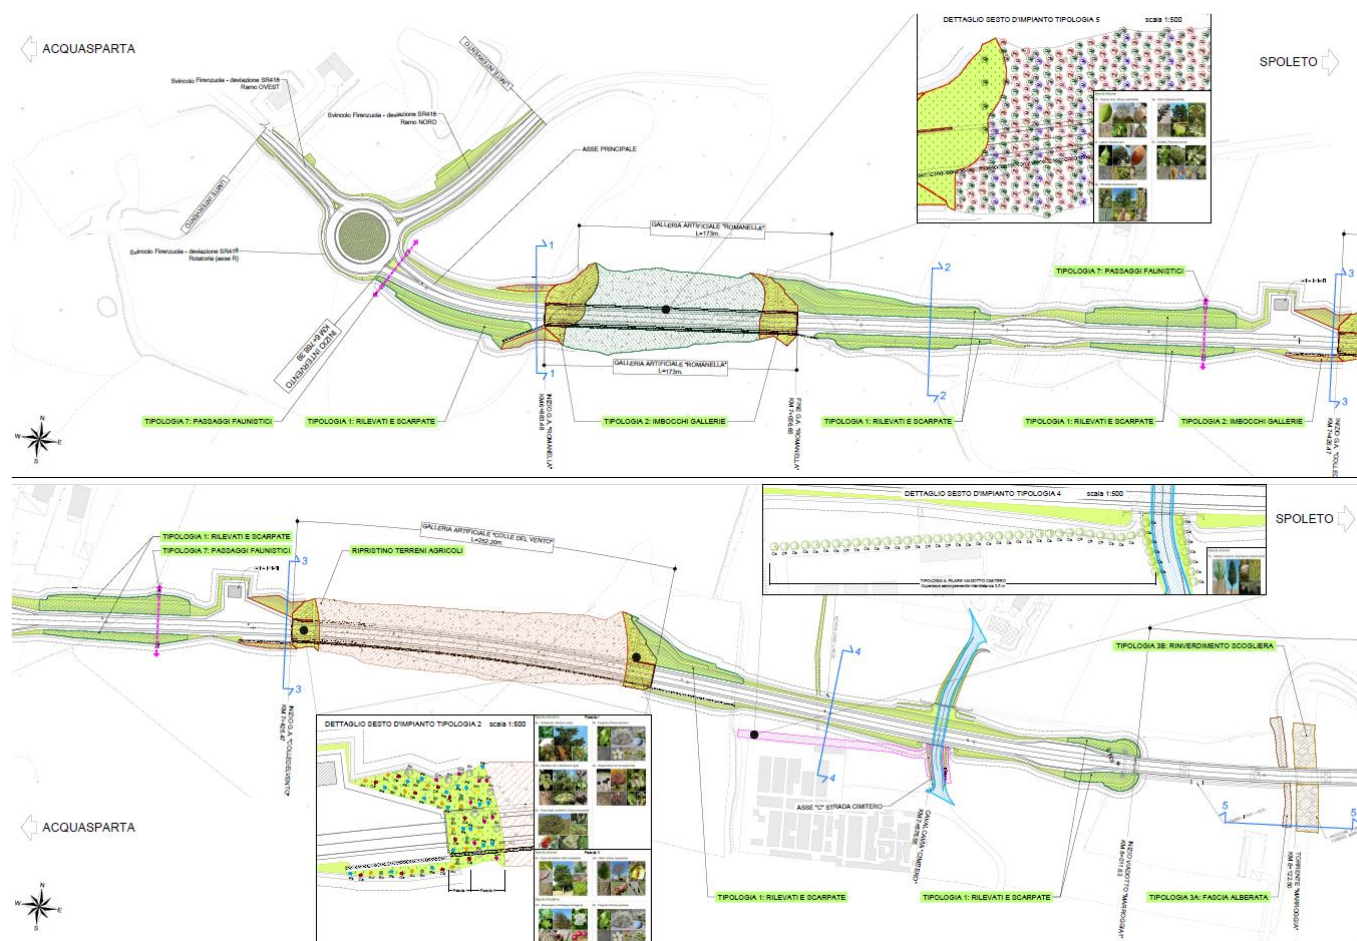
Stralcio planimetrico della planimetria delle opere di mitigazione ambientale, con l'evidenza delle due gallerie artificiali.
